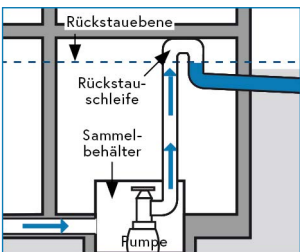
Im Falle einer Nachrüstung gegen Kanalarückstau sollte bevorzugt eine Hebeanlage eingebaut werden. Sie schützt auch im Falle eines Defekts.
